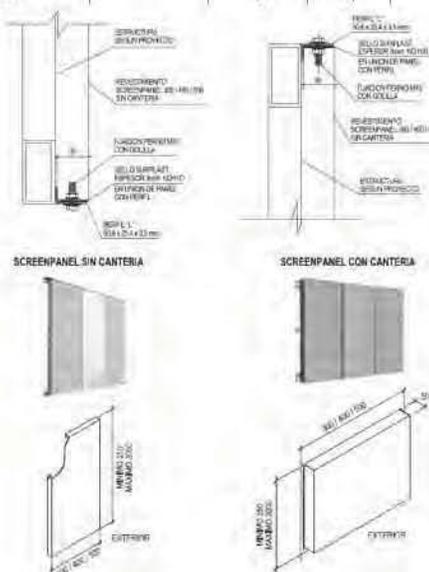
Detalles constructivos de la segunda piel así como su modulación.
